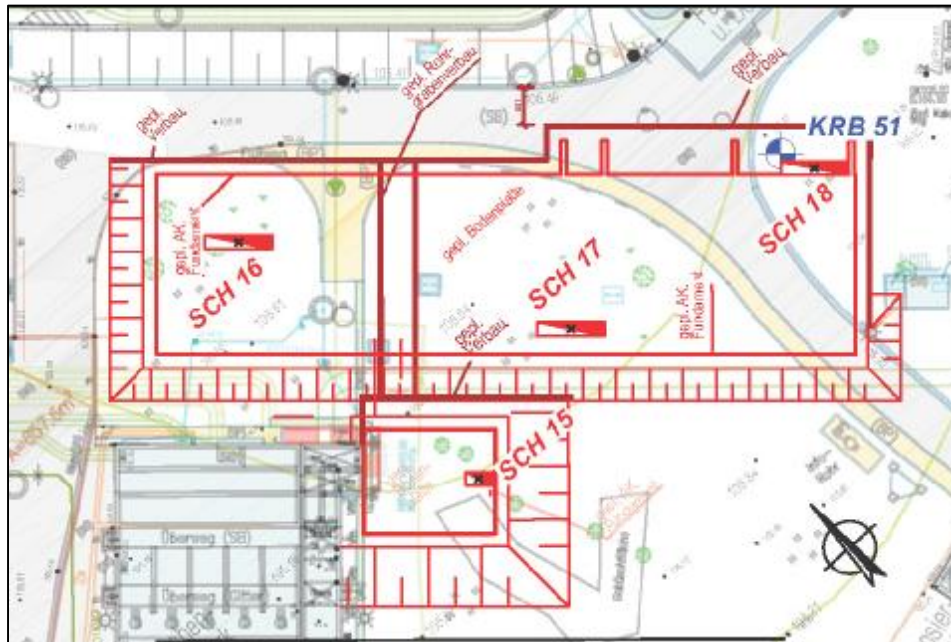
Lageplan mit Darstellung der geplanten Baggerschürfe – Verdichterstation, Verteilerbauwerk
